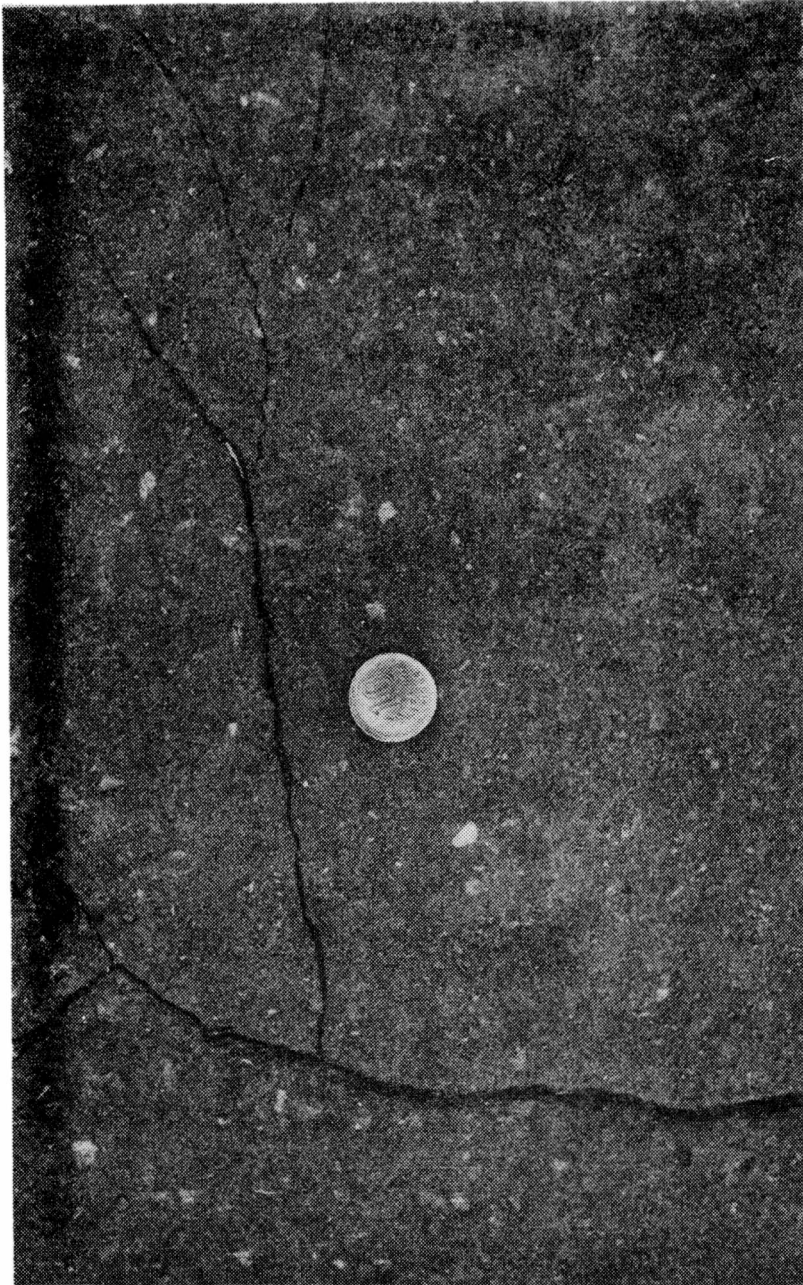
Fisuras debidas a la contracción de la carpeta
